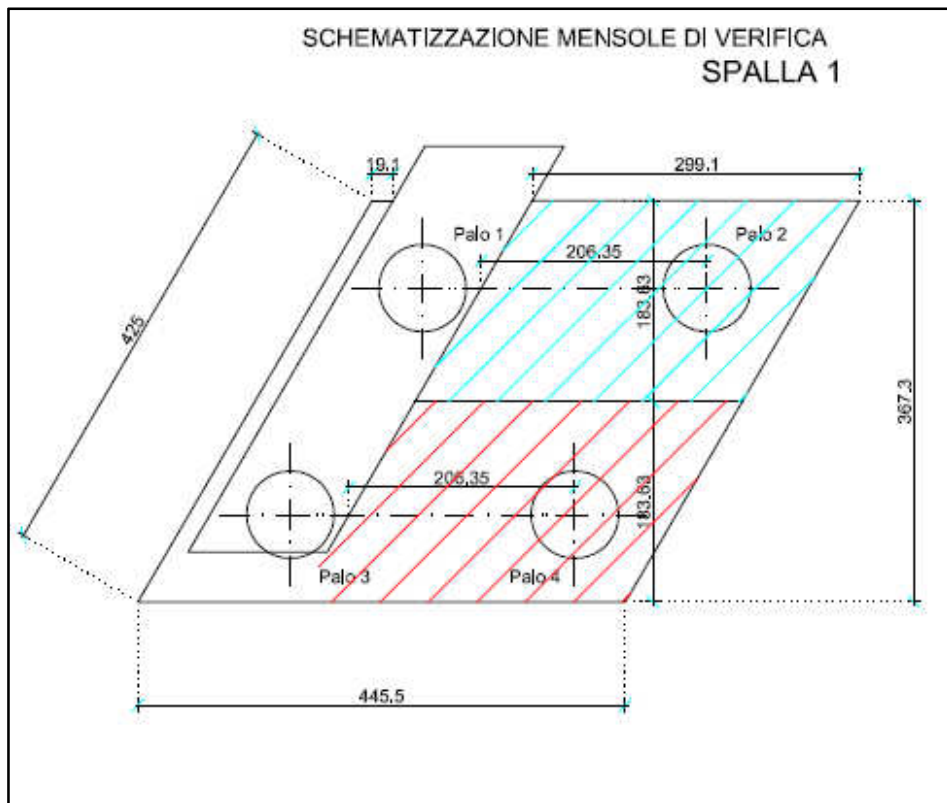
Platea e palificata di fondazione della piedritto/spalla 1 – schematizzazione mensole per calcolo sollecitazioni di verifica platea
